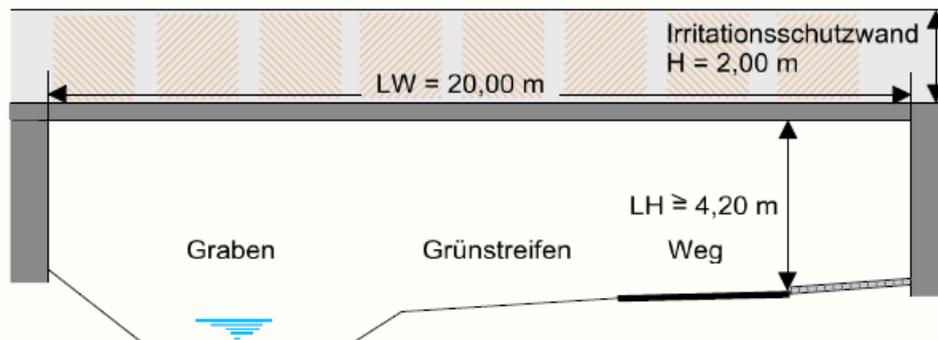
BW Gerb 07 - Unterführung Wirtschaftsweg und Mühlentalgraben
